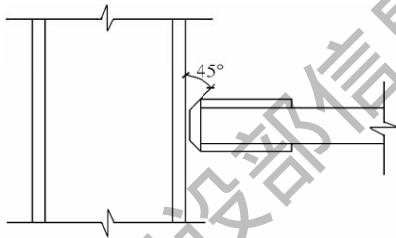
可焊接机械连接套筒焊接示意
